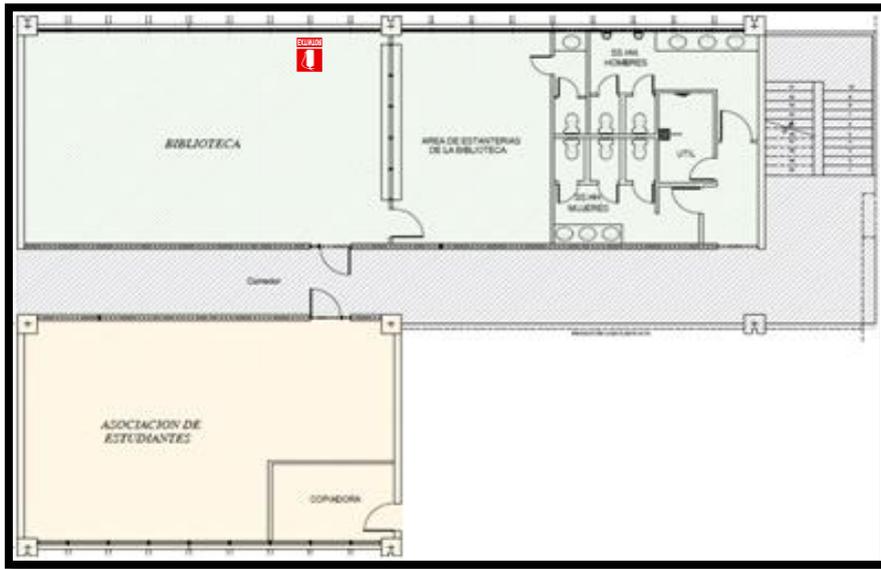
Extintores, Planta baja, Edificio 24-D, Zona 3
